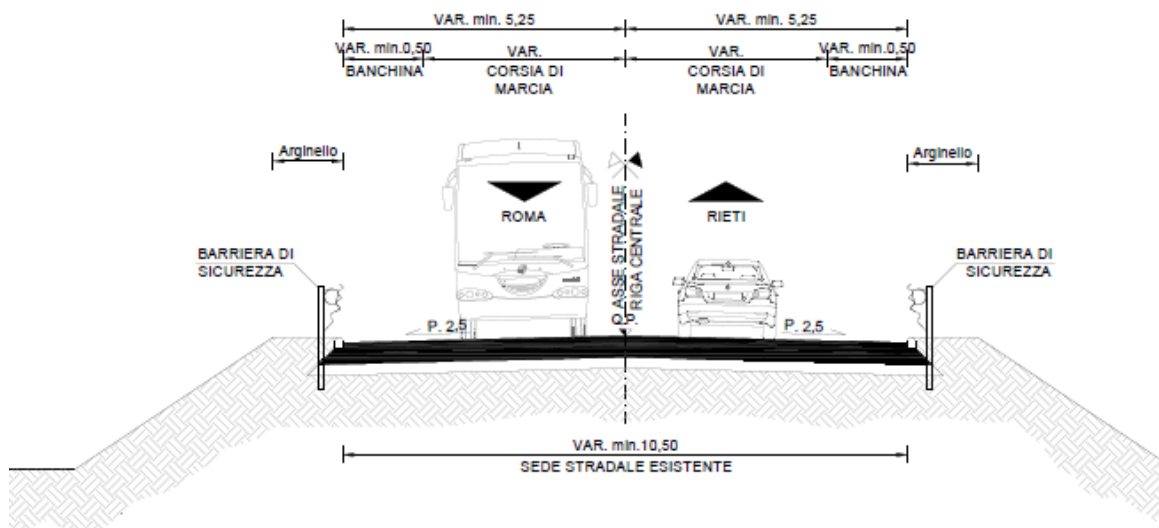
Piattaforma stradale esistente – Sezione tipo in rettilineo (Fonte: Allegati alla Lista di controllo)
